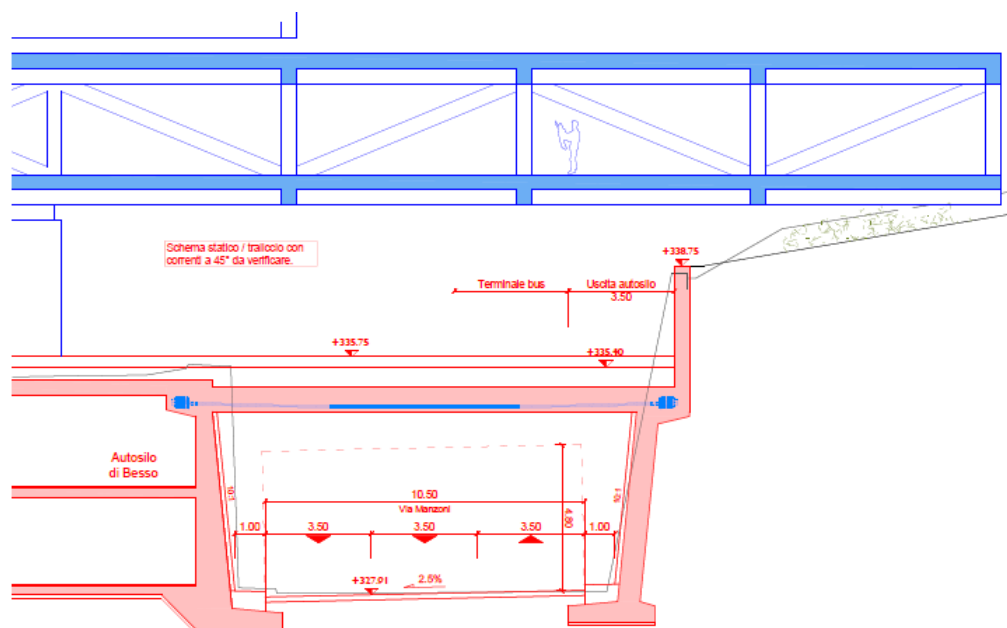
Prolungo copertura tunnel di Besso, con sopra collegamento al parco Lucerna
